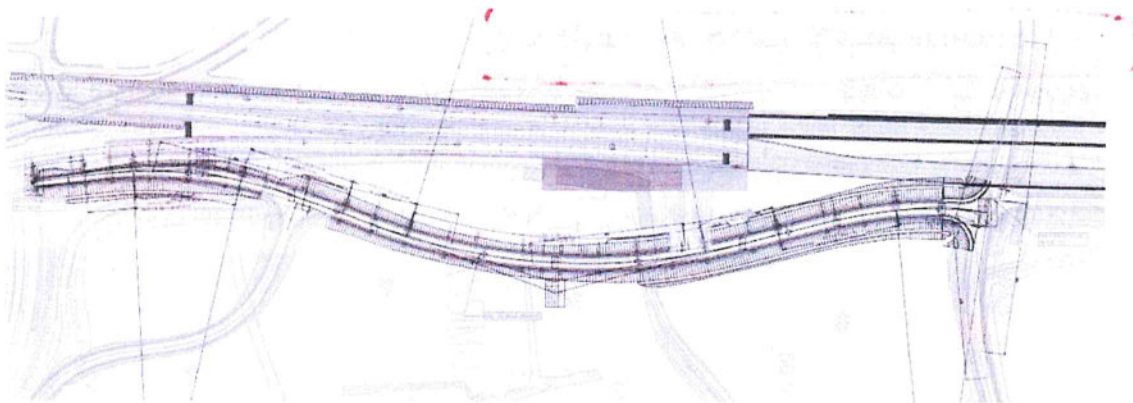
Stralcio planimetrico su rilievo Via della Spianà definitiva
